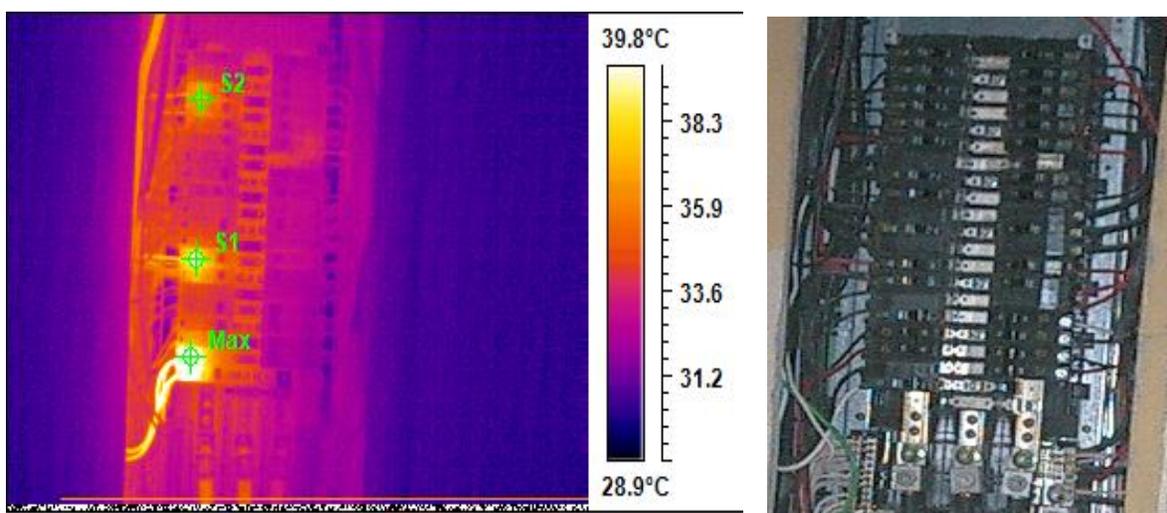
Tablero Baja Tensión Alimentación Planta Baja Edificio Docencia "D"
